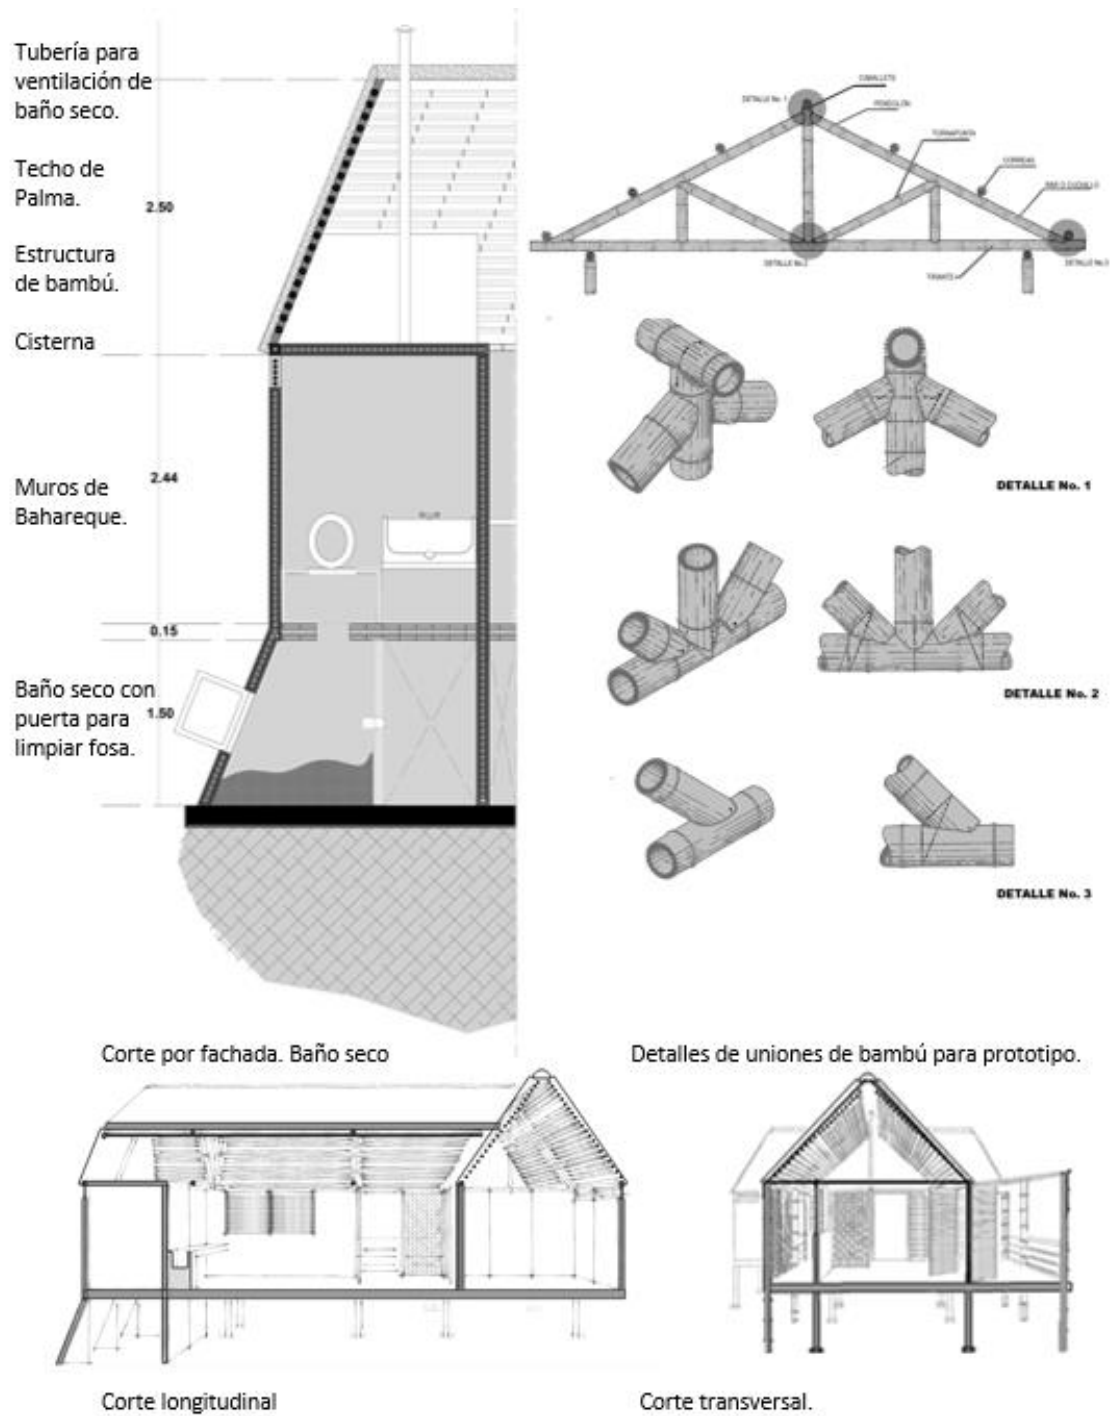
Esquemas de detalles constructivos para el prototipo de vivienda
